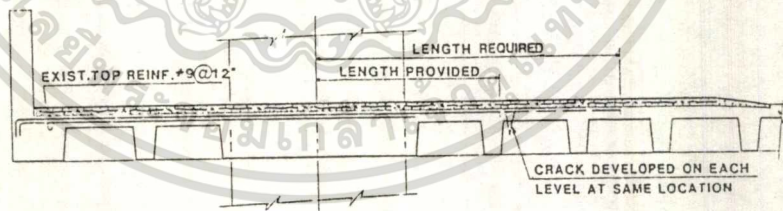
ภาพตัดขวางของพื้นลานจอดรถแสดงให้เห็นความสัมพันธ์ระหว่างพื้นยื่นกับพื้นช่วงใน
